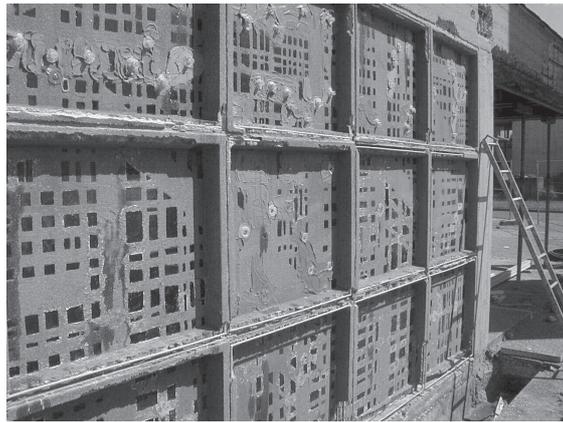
Klebpacker über verdämmten Rissen von Betonfenstern
